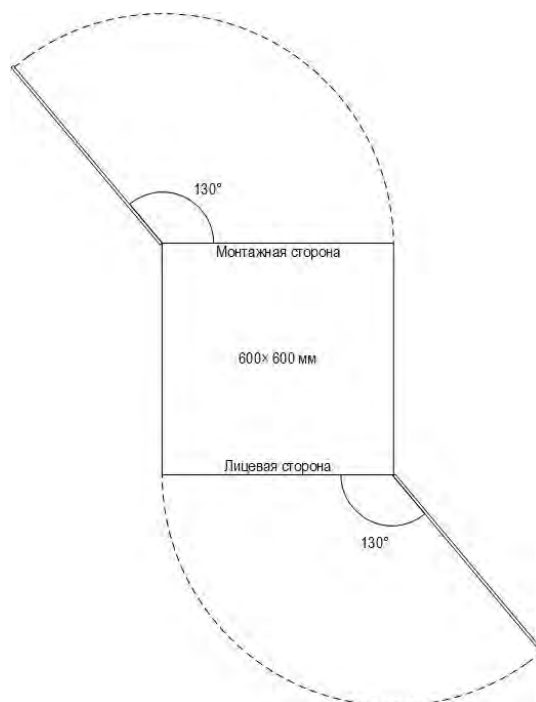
План площади помещения, занимаемой одним шкафом ОК-И с учетом максимально возможного угла открытия дверей шкафа (вид с верху)
